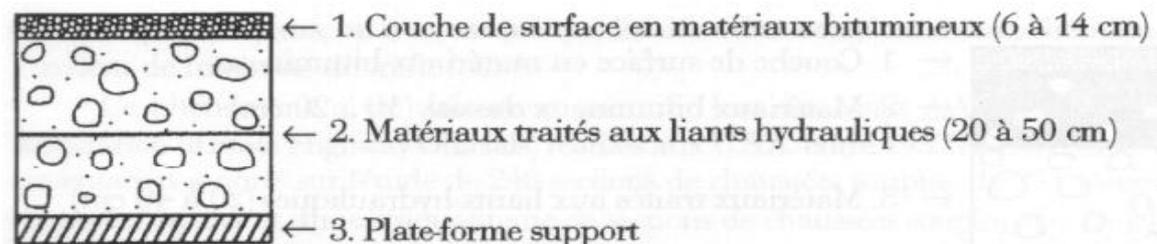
Chaussée à assise traitée aux liants hydrauliques [Catalogue des chaussées, 1998]
